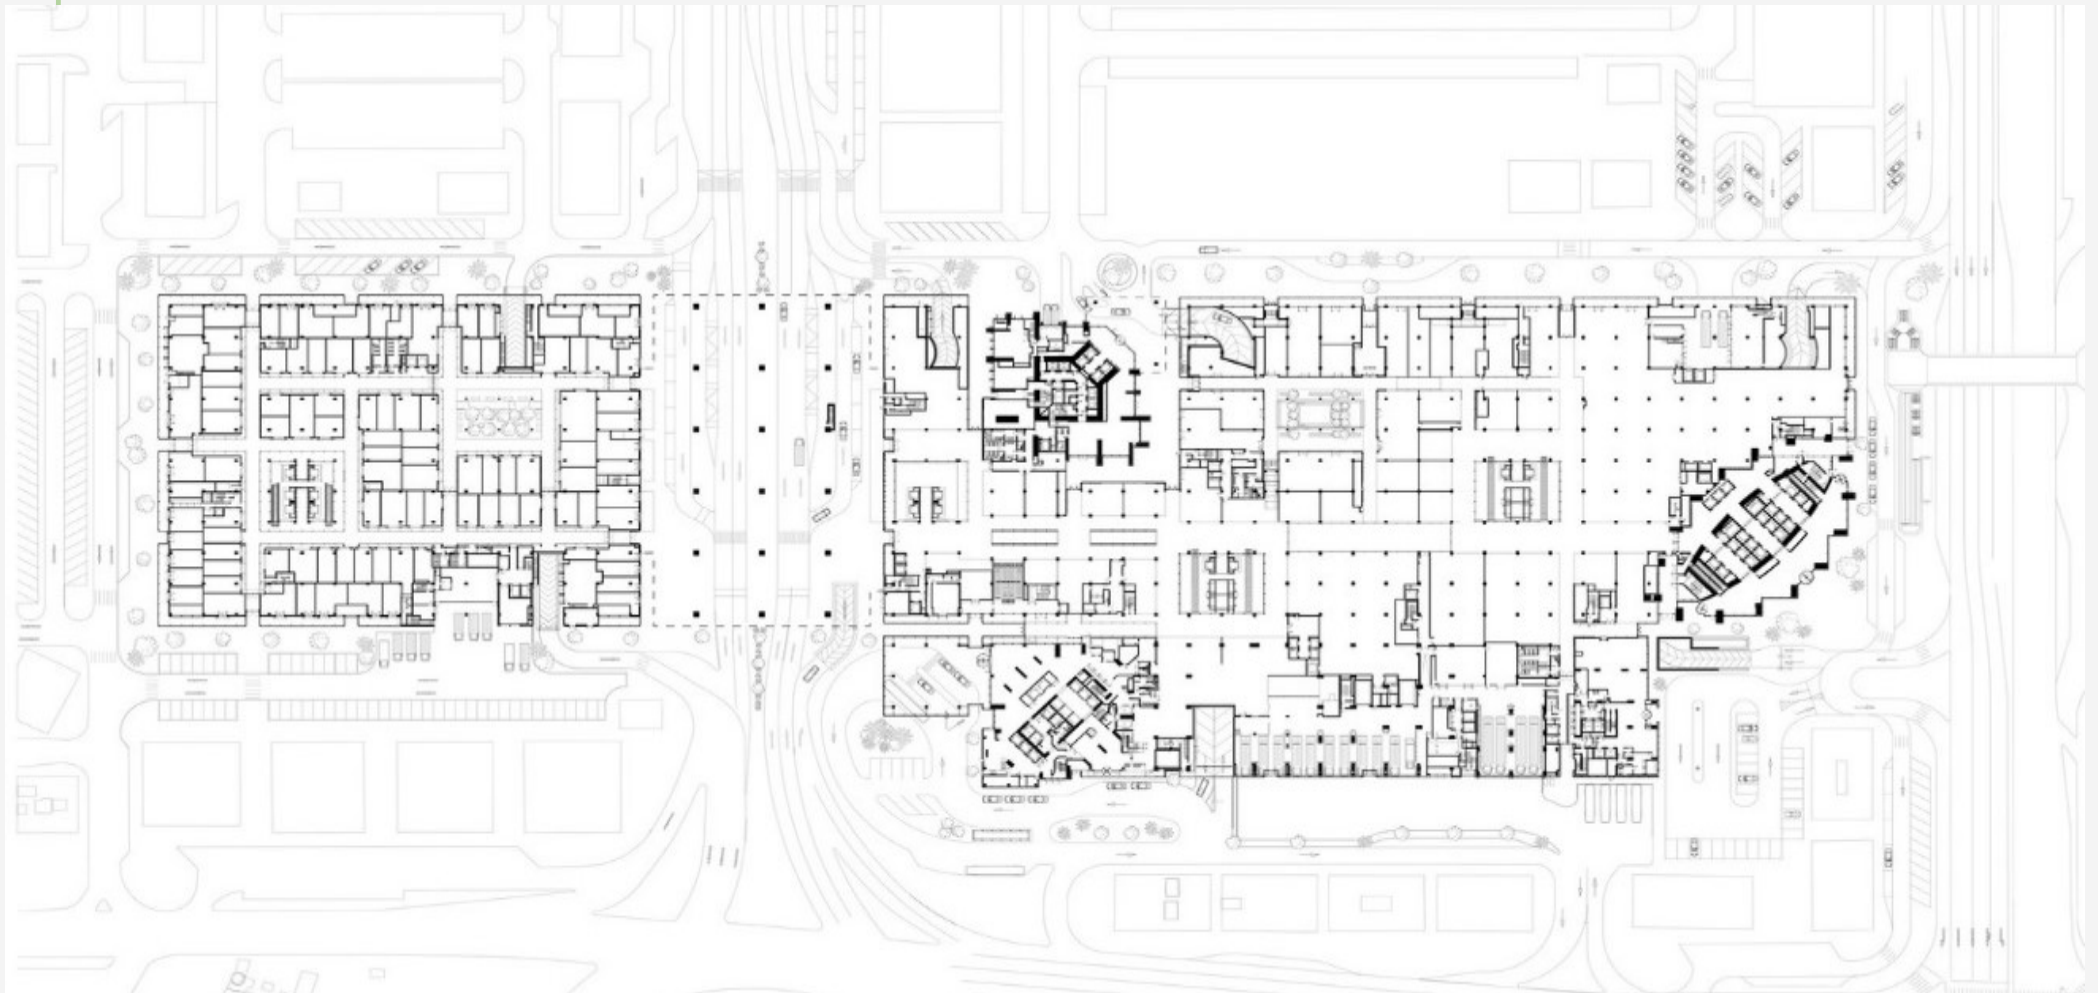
Planta baja general del mercado central de Abu Dabi. Fuente: Ecosistema Urbano (2022)
